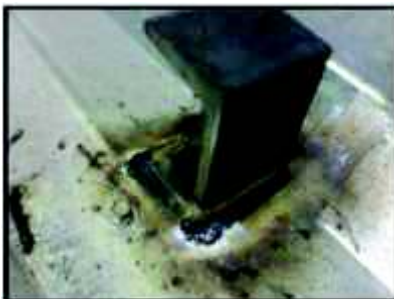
Detalle de conector de corte tipo canal laminado en caliente.
